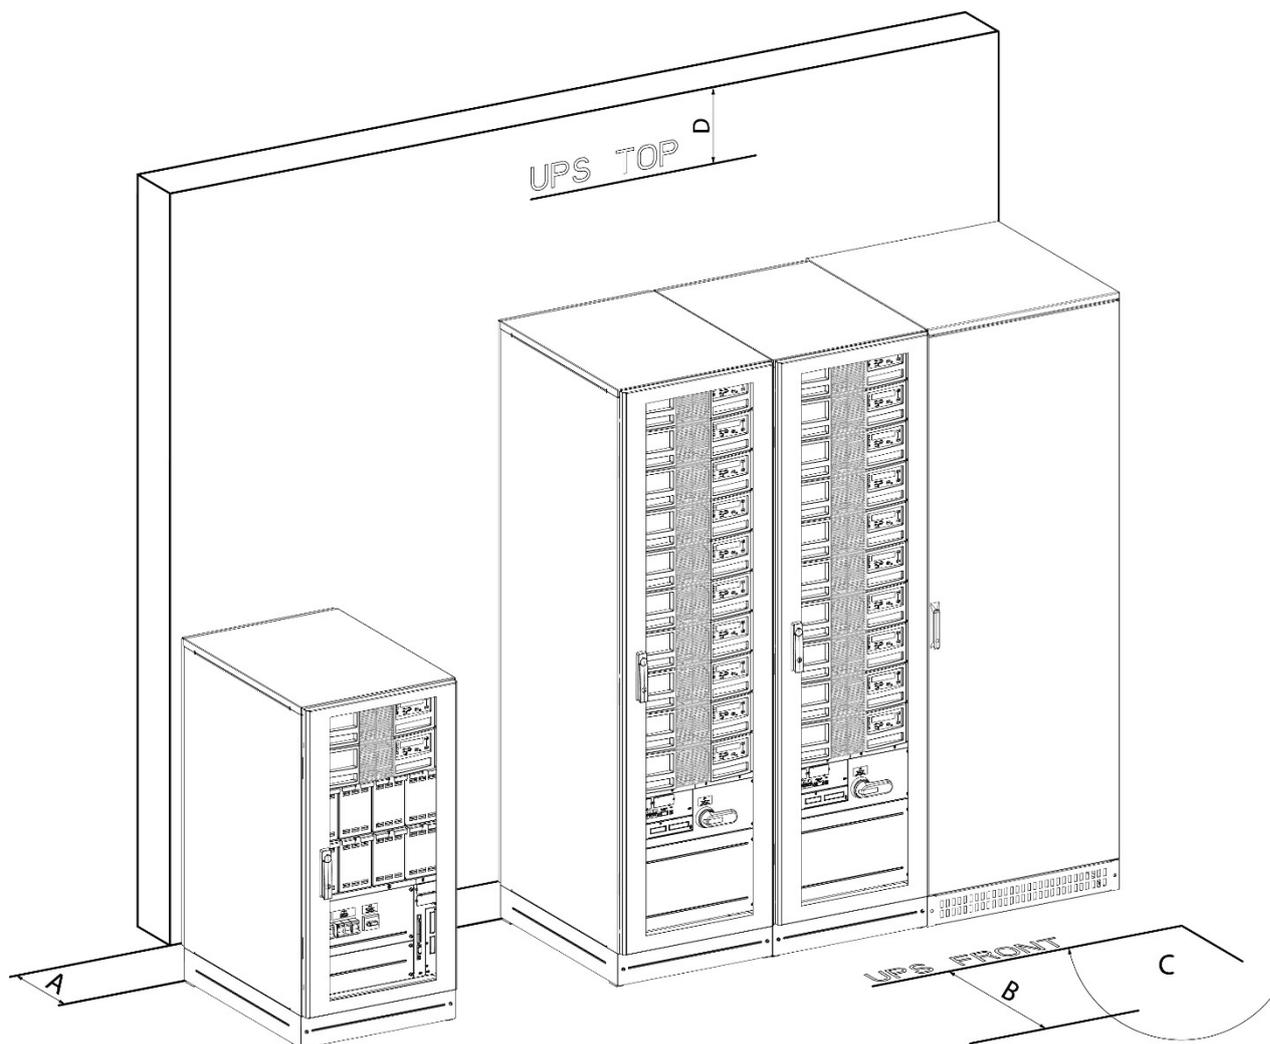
Installationsort USV und Batterie (Abstände)
